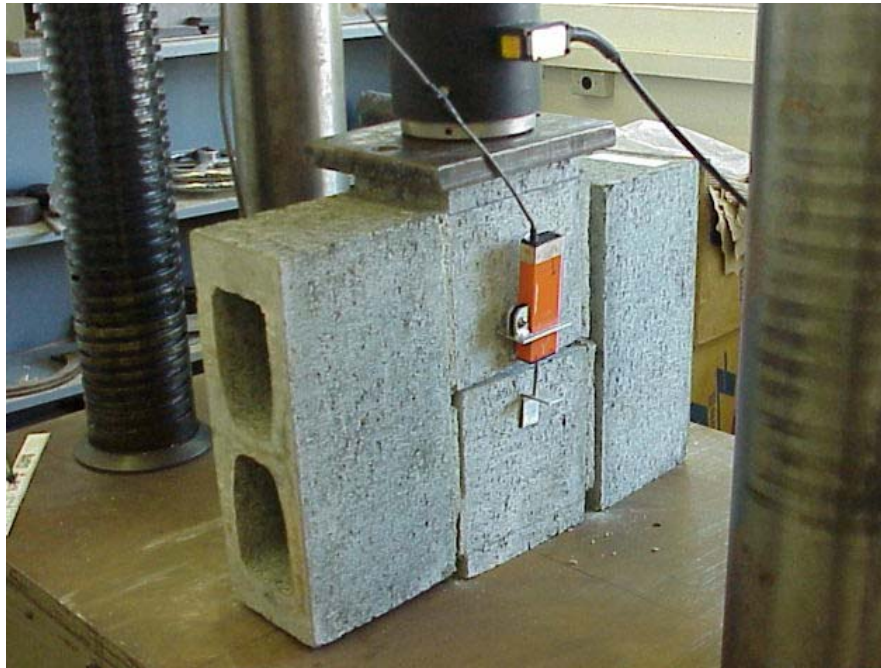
Foto do ensaio de cisalhamento sem pré-compressão.
